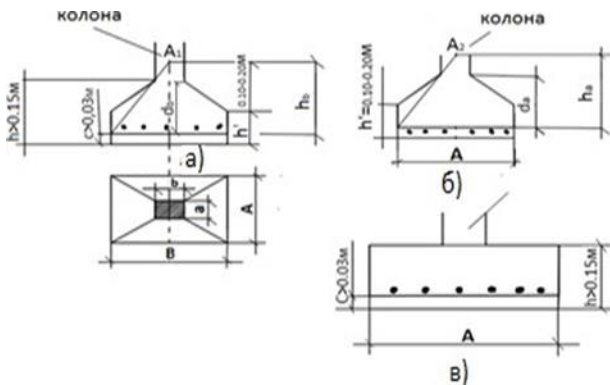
Принципові розрахункові схеми фундаментів, що використовують в Республіці Конго: а) залізобетонні окремо стоячі фундаменти під колони; а) і б) розрізи.
